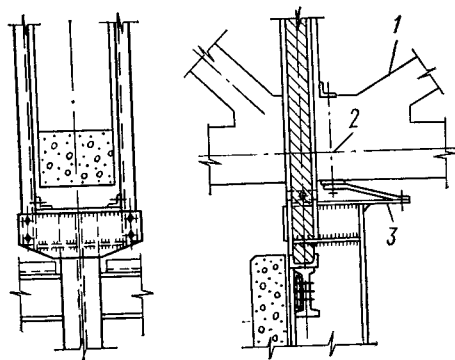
Пример крепления стоек факверка внутренней стены к несущим конструкциям здания
